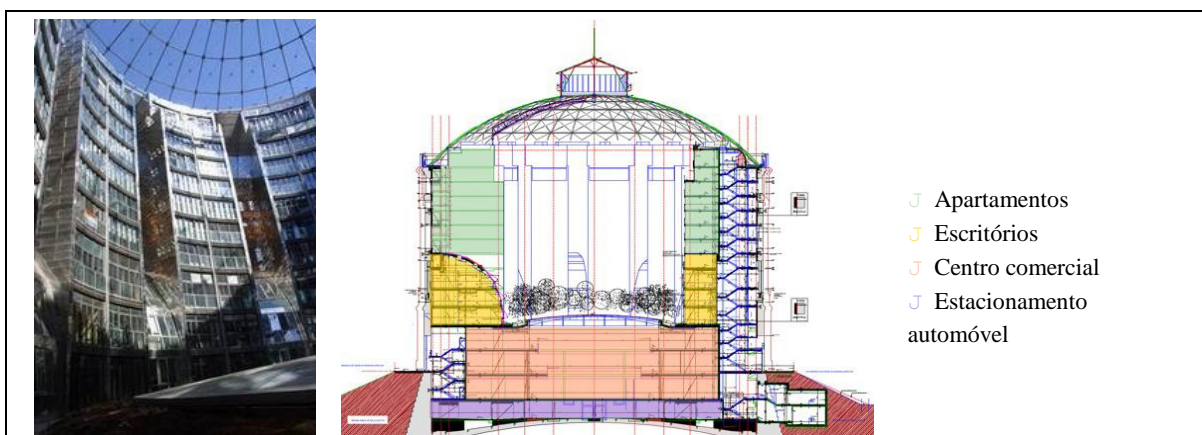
Tanque A: interior e corte esquemático [71]
